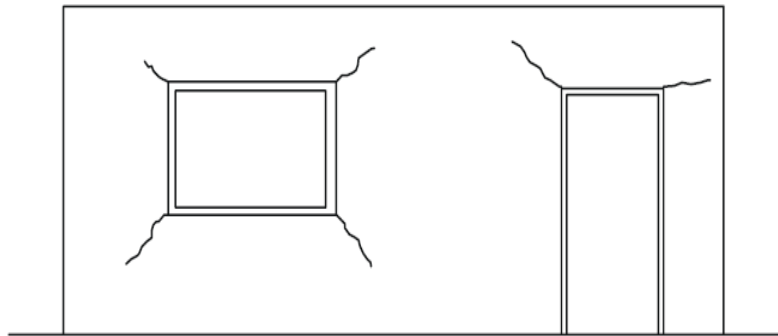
Fissuração real em torno de aberturas em parede submetidas a sobrecarga (THOMAZ, 1989).
